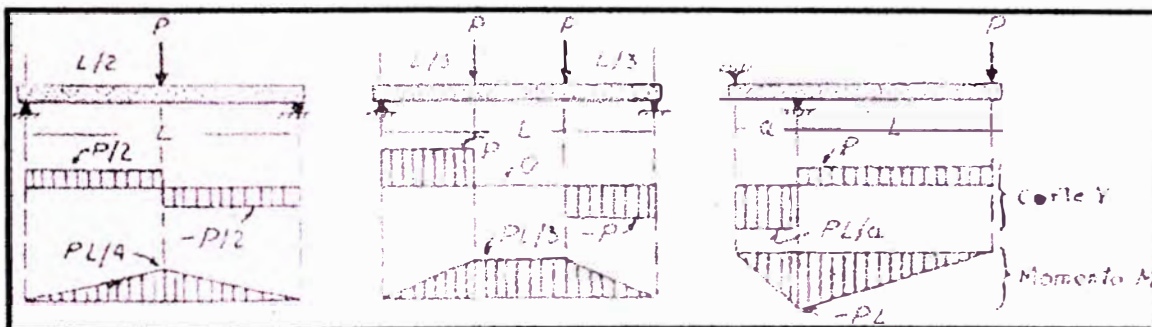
Distribución de las fuerzas de tensión sobre la viga de ensayo.
